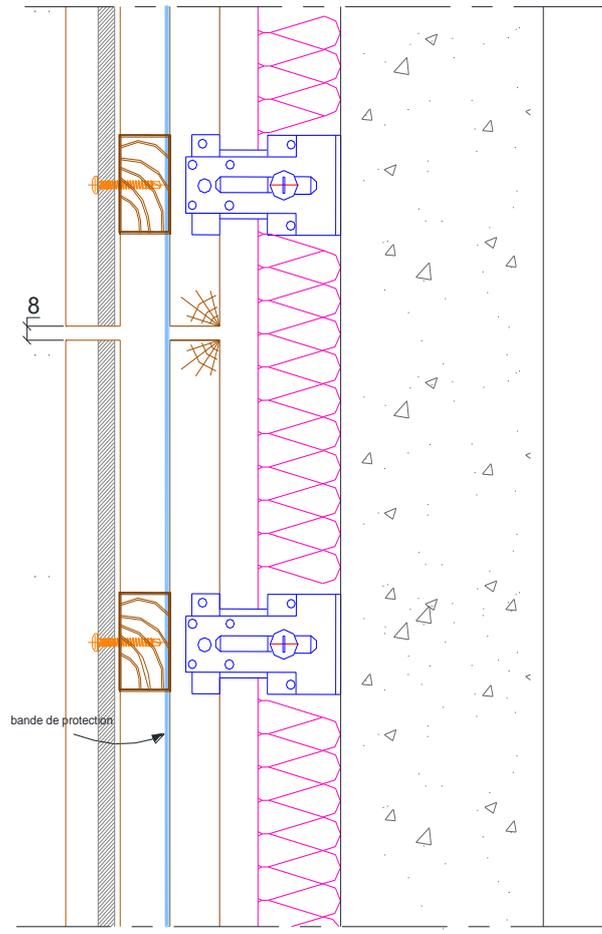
Fractionnement de l’ossature en pose verticale: Chevrons de longueur $\leq 5,40m$
